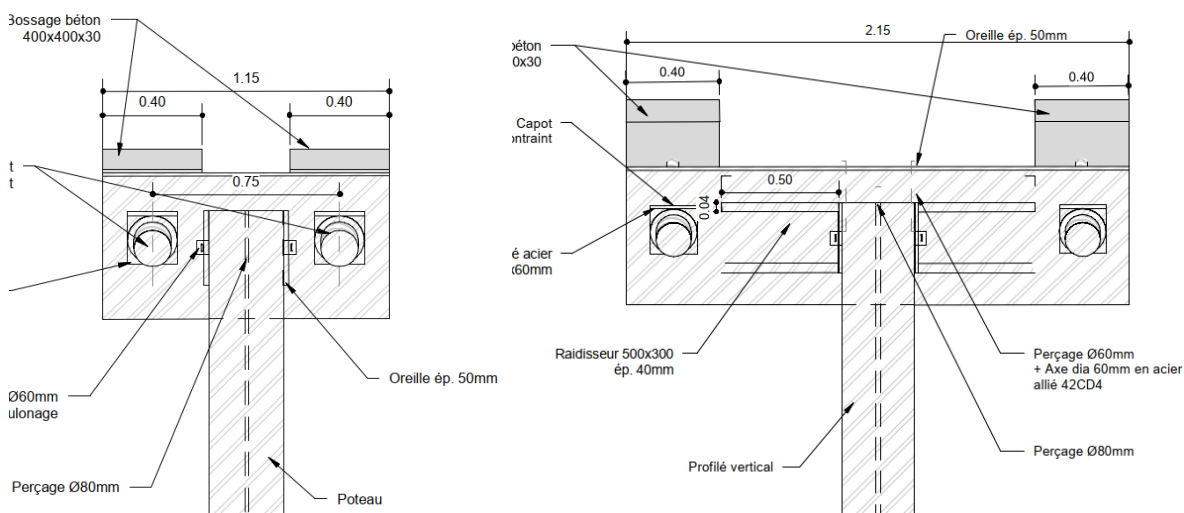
platine d'ancrage haut des consoles : vue de face de la platine (console courante et console sur VSP)
